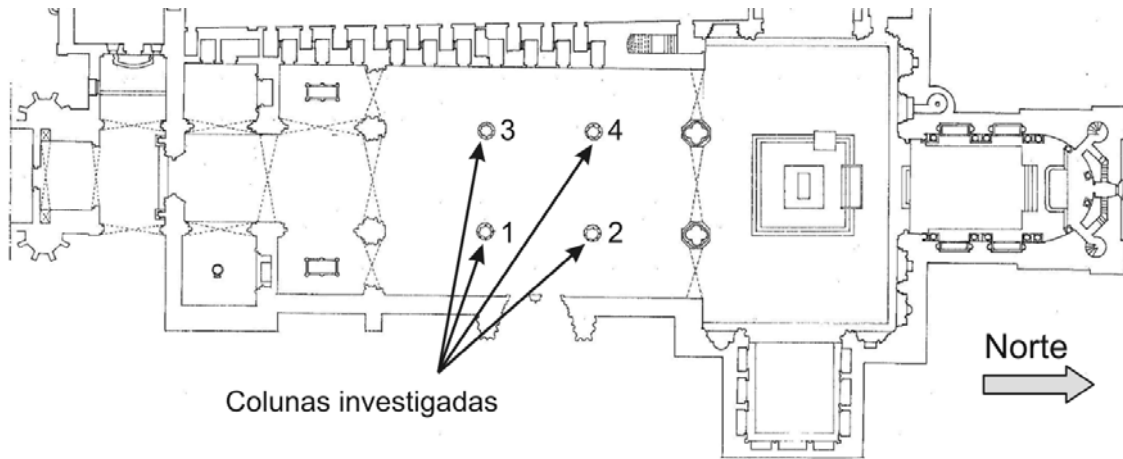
Vista geral da planta da nave da Igreja e do local dos ensaios com GPR.
